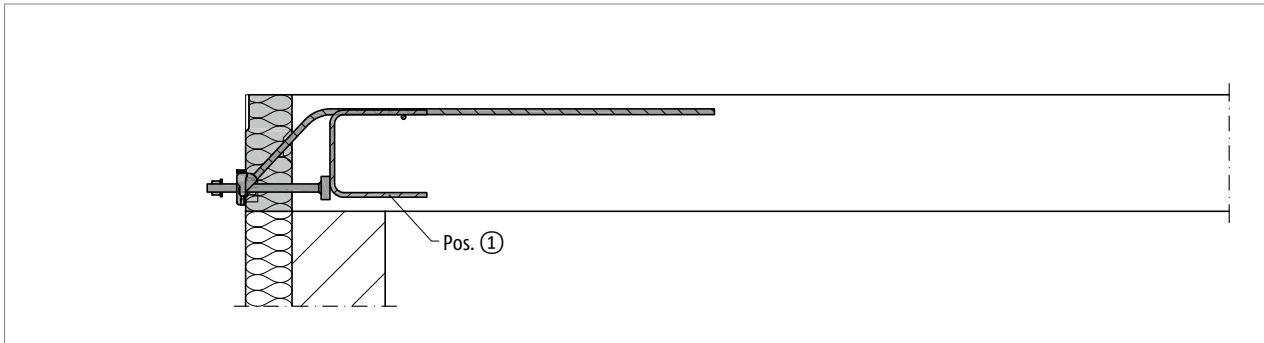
Schöck Isokorb® T type SQ: Op de werf aangebrachte brandwerende bekleding, T type SQ, staalconstructie met brandwerende coating; doorsnede
